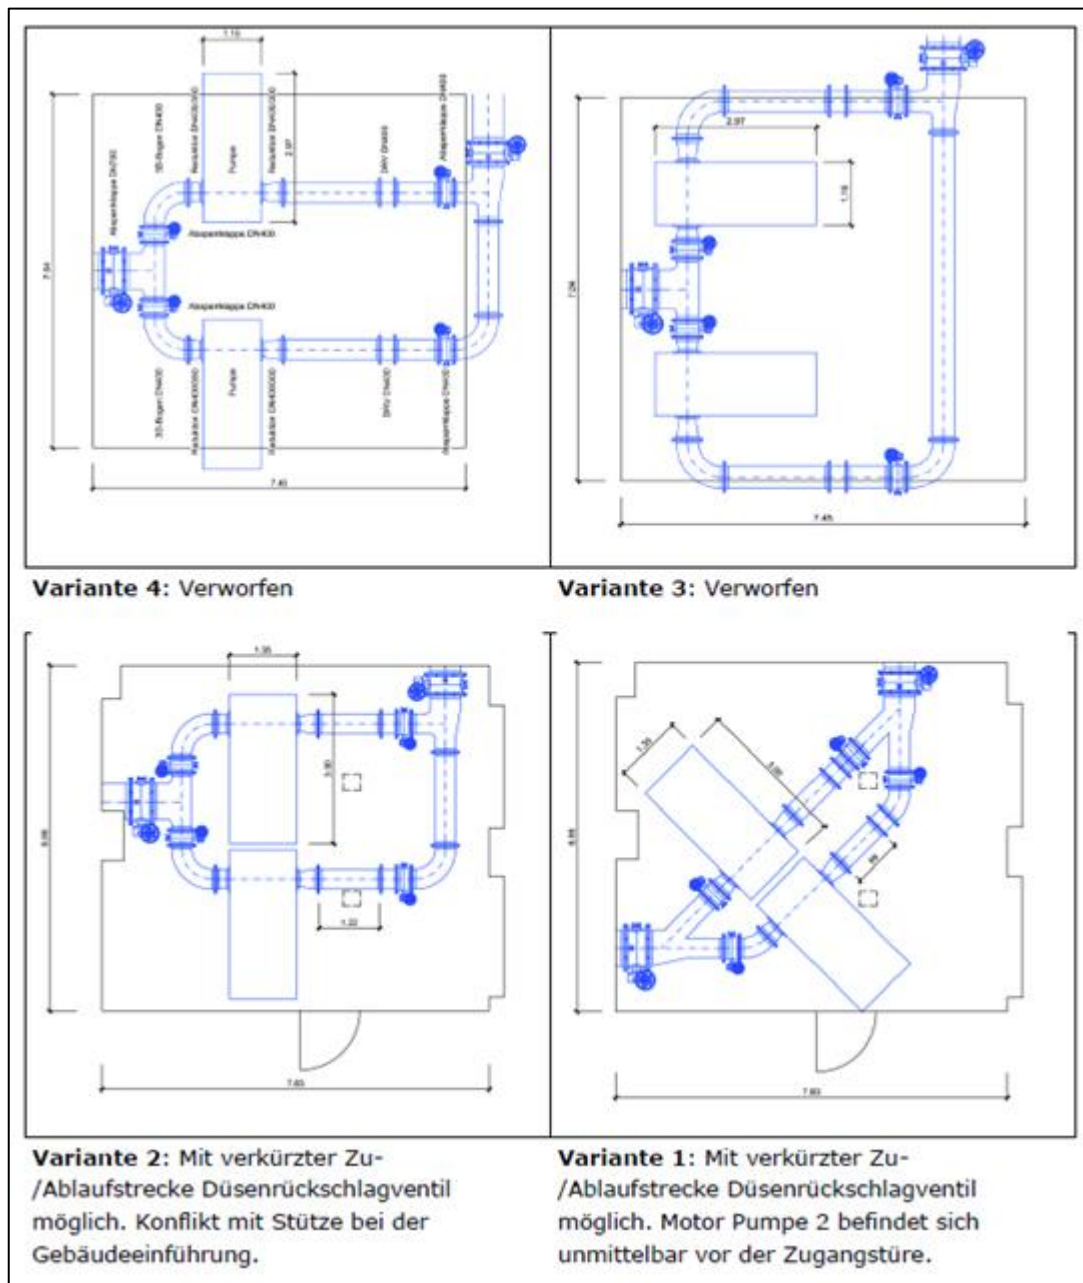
Unterschiedliches Layout der Rohrleitungsführung bei festgelegter Bauform
